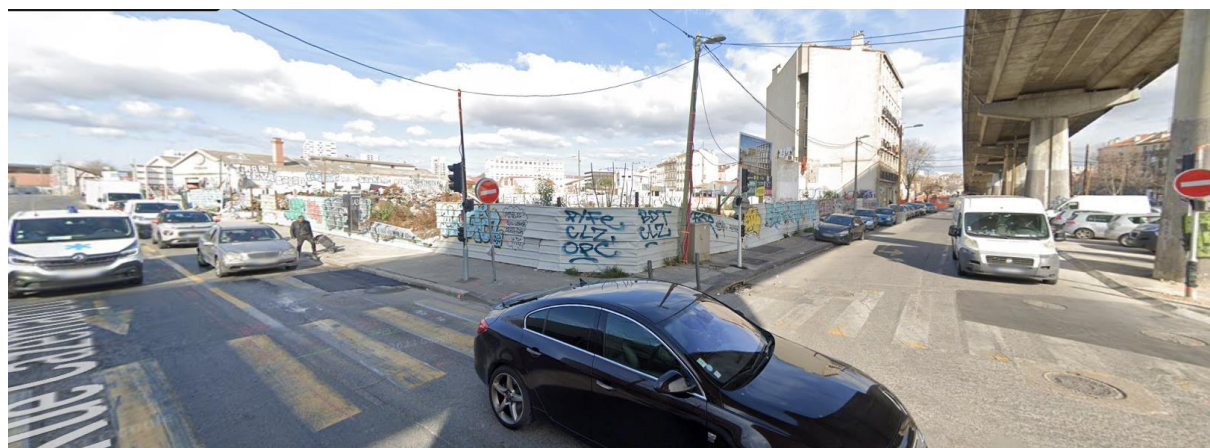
Vue actuelle du carrefour de la "Place Cazemajou"
